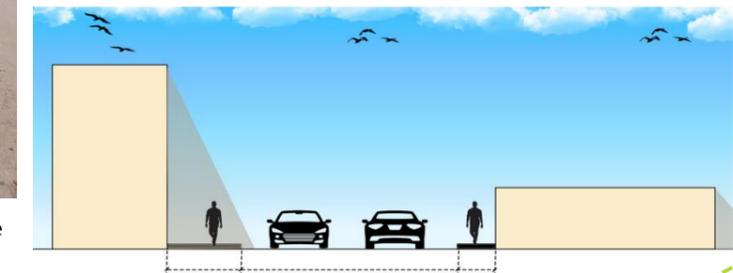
Coupe BB' ( sur rue Secondaire) (Source : Auteur)
